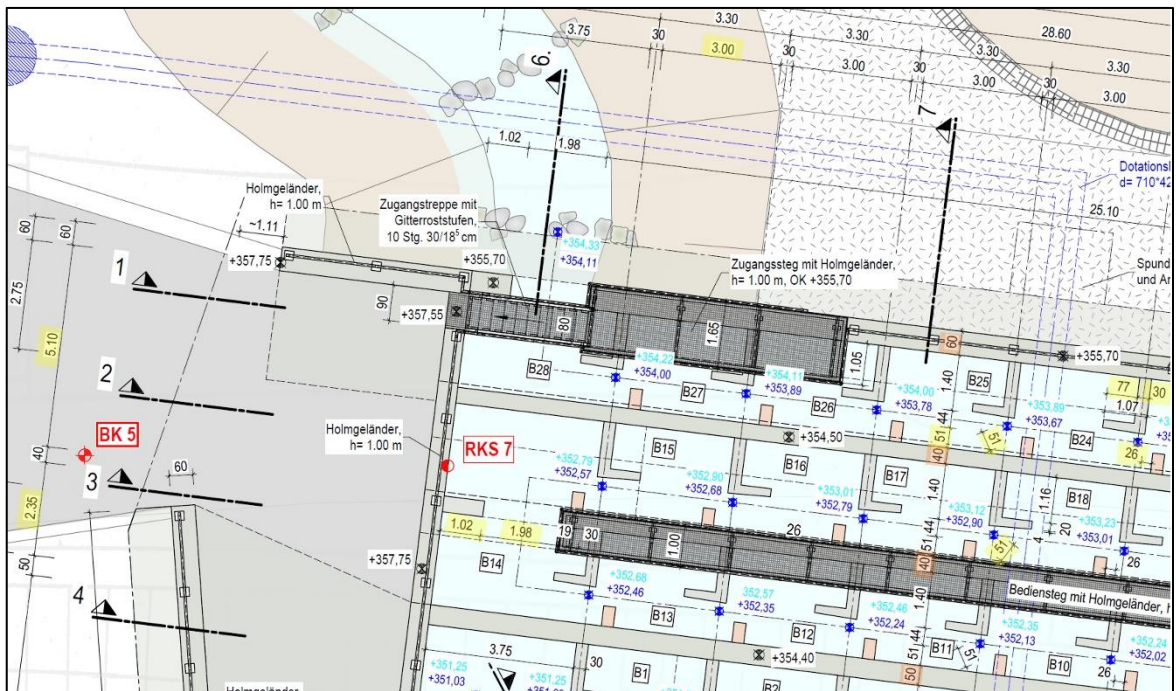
Regelabmessungen Becken Einstiegsbauwerk - Schlitzpass
